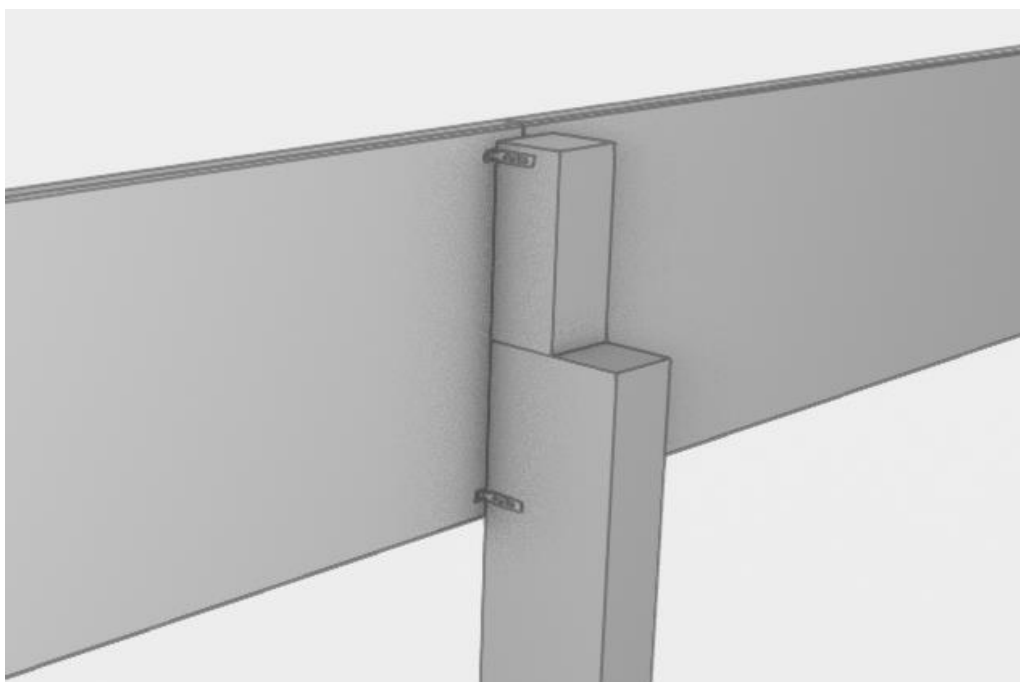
Pilar pré-fabricado de concreto com insertos para apoio de painel.
